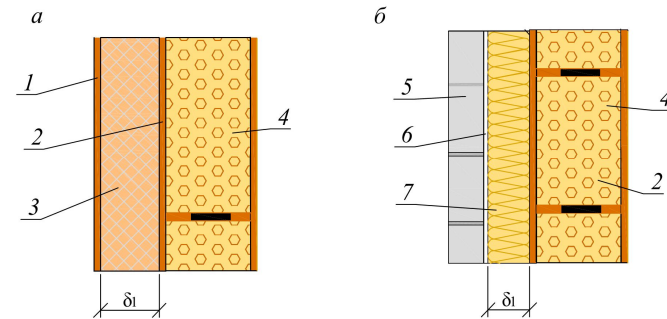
Конструкция наружной стены из легких керамических блоков с наружной изоляцией (а – и штукатурным слоем; б – и слоем из облицовочного кирпича): 1, 2 – штукатурный слой; 3 – внешняя негорючая тепловая изоляция; 4 – кладка из керамических блоков; 5 – облицовочный кирпич; б – 20 мм вентилируемого слоя
